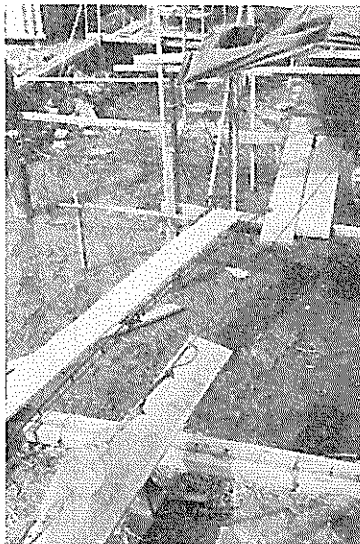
Pile No. 2 および Pile No. 4 の載荷
